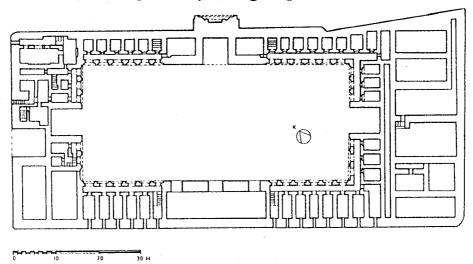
مسقط أفقي لجامع الحيدرخانه ببغداد (عن : كوبان) .
